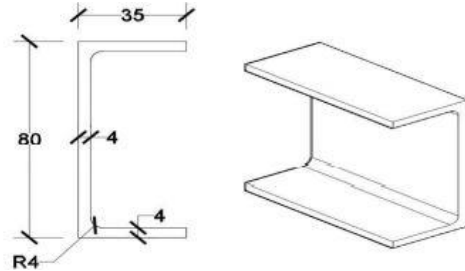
Balok Lantai 2 Dengan Label B 21 24 Dalam mendesain balok dengan shear connector yang akan digunakan ialah balok lantai 2 dengan label B21 yang menghasilkan momen balok yang paling besar. Dimensi Balok
